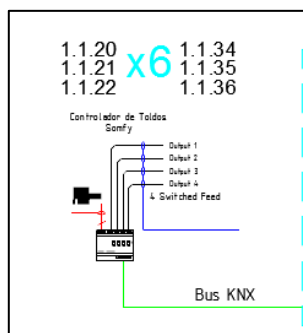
Controlador de Toldos en esquema de Planta Primera
